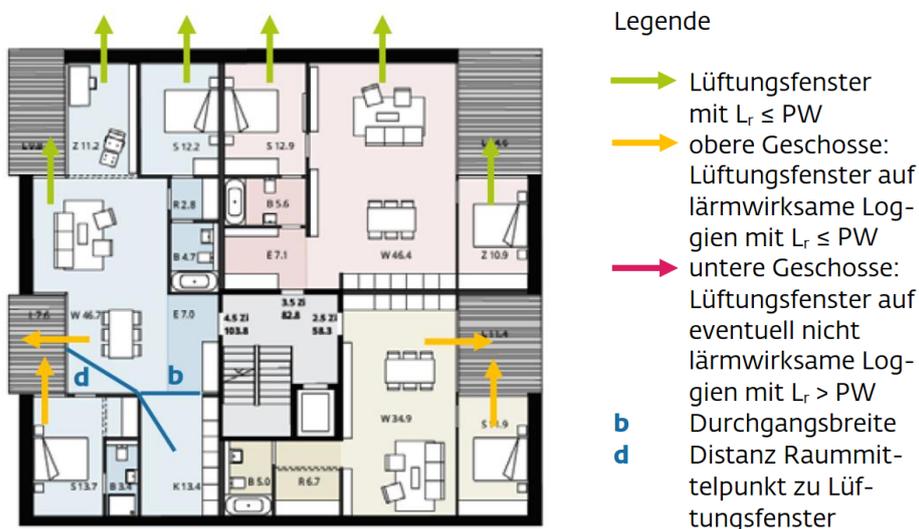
Grundriss Richtprojekt, 3 bis 5. OG
